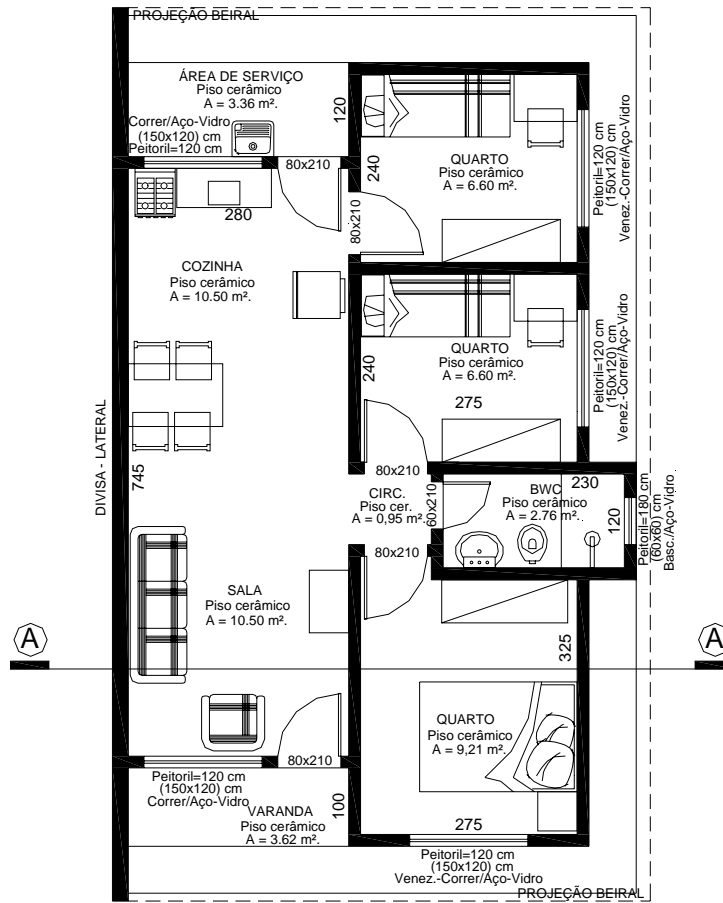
Implantação da tipologia em alvenaria nova 2 – 4ª fase
